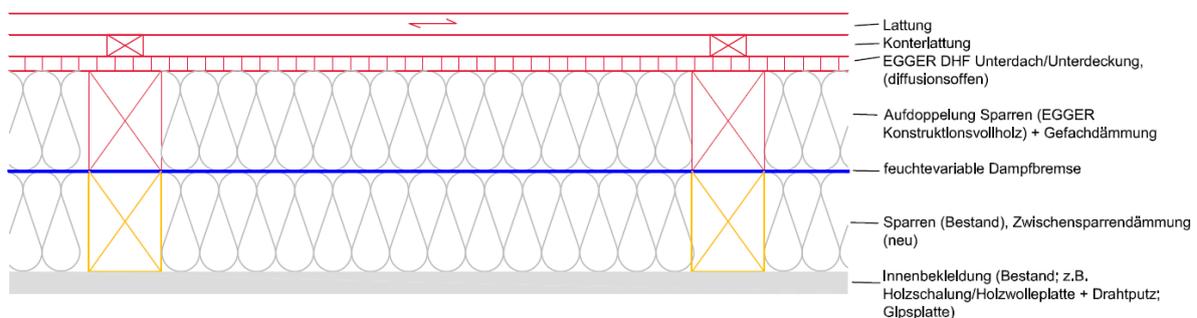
Sanierung mit Sparrenaufdoppelung aus Konstruktionsvollholz und ebener Dampfbremse
